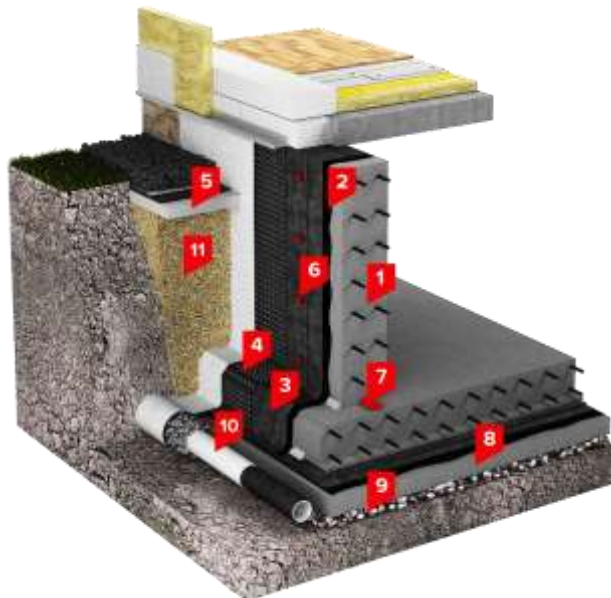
Конструктивне рішення підземної частини будівлі з стрічковим фундаментом: 1 – залізобетонні конструкції підвалу; 2 – праймер бітумний; 3 – рулонна гідроізоляція; 4 – профільована мембрана; 5 – екструзійний пінополістирол; 6 – кріплення для фіксації плит і мембрани; 7 – шнур, що набухає; 8 – бетонна підготовка; 9 – щебенева підготовка; 10 – дренажна труба; 11 – ґрунт зворотної засипки
